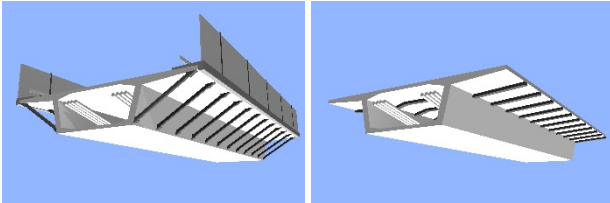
Verstärken einer Hohlkastenbrücke in Querrichtung durch stützende Streben (links) oder durch Rippen unter der Fahrbahnplatte (rechts)
